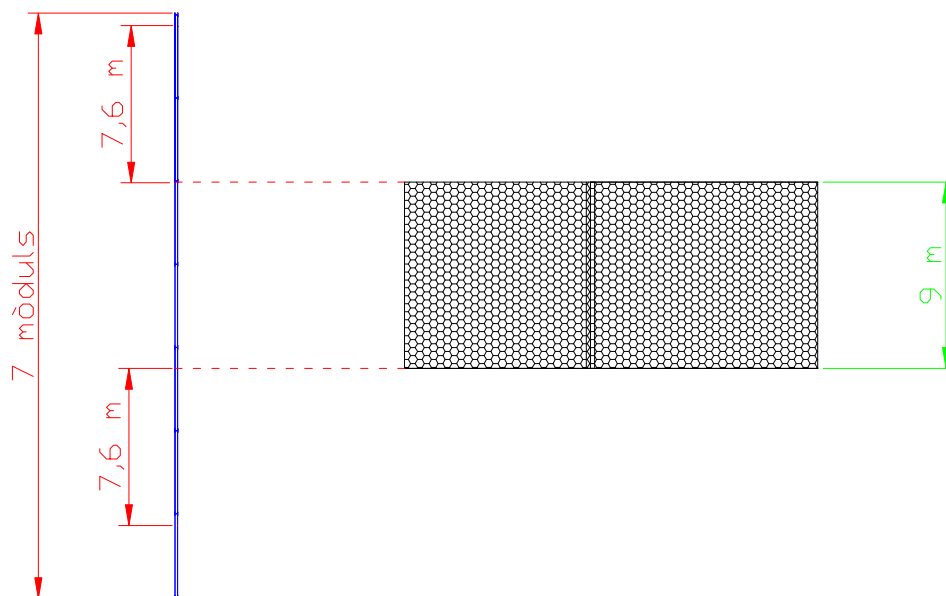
Croquis vista planta situació pantalla respecte R6.
